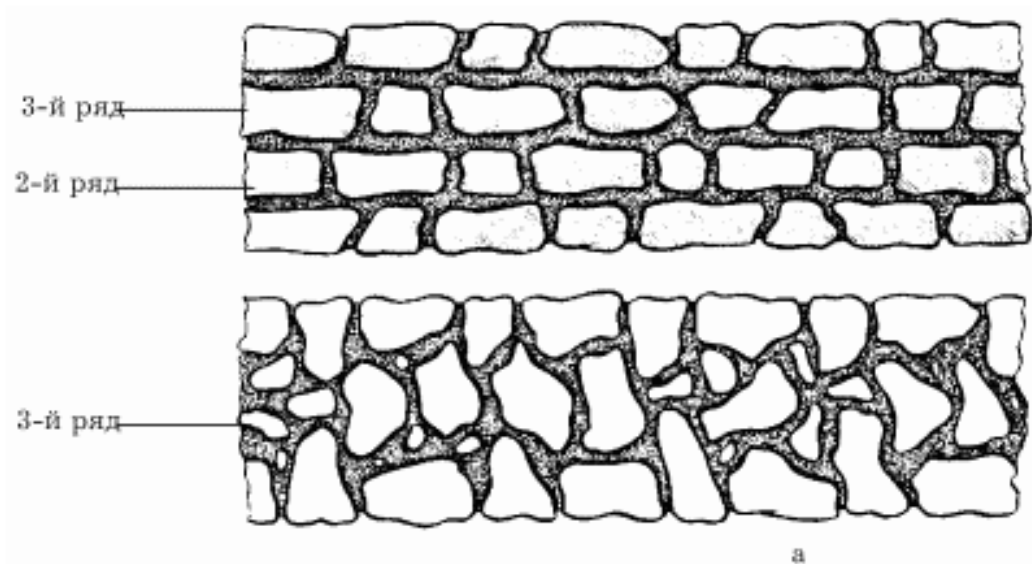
Перевязка кладки из бутового камня: а – стены.
